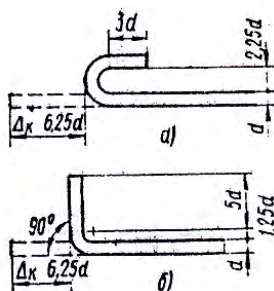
Размеры крюка (а) и лапки (б) на концах круглых гладких стержней рабочей арматуры
